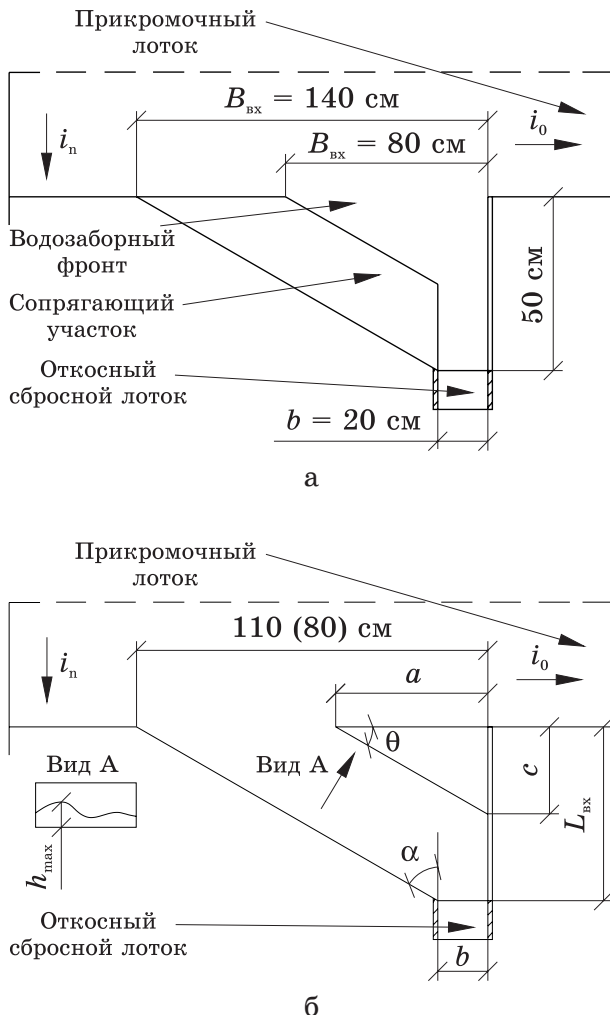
План входного участка сбросного лотка: а – прямоугольное очертание левой сопрягающей стенки; б – треугольное очертание левой сопрягающей стенки
